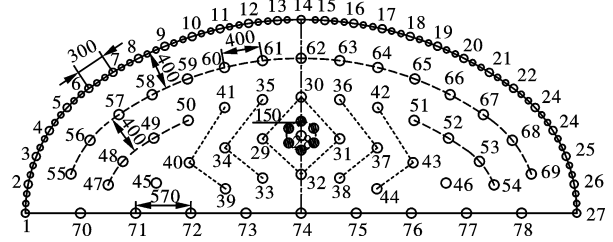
上分层混凝土段一阶炮孔布置图(单位:mm)
